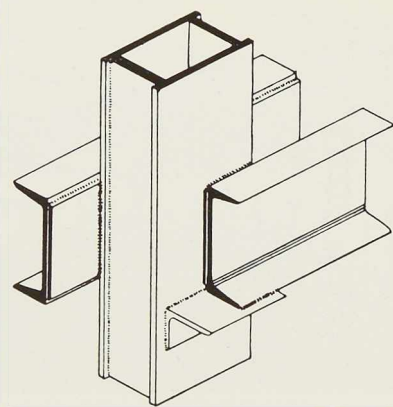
Assemblage des poteaux sud avec les entretoises.
